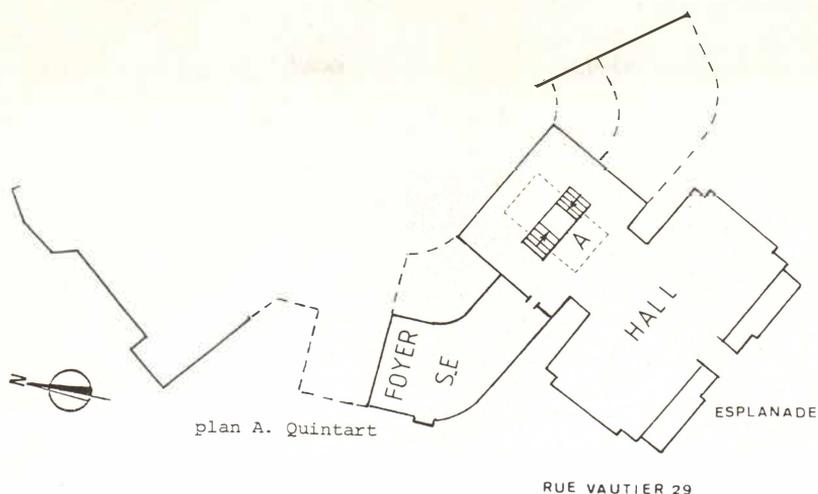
Plan du hall et de la salle A qui forment un ensemble; pour passer à la salle B, il faut descendre par un des escaliers. Du hall, on atteint également les salles M et N par des escaliers latéraux.
